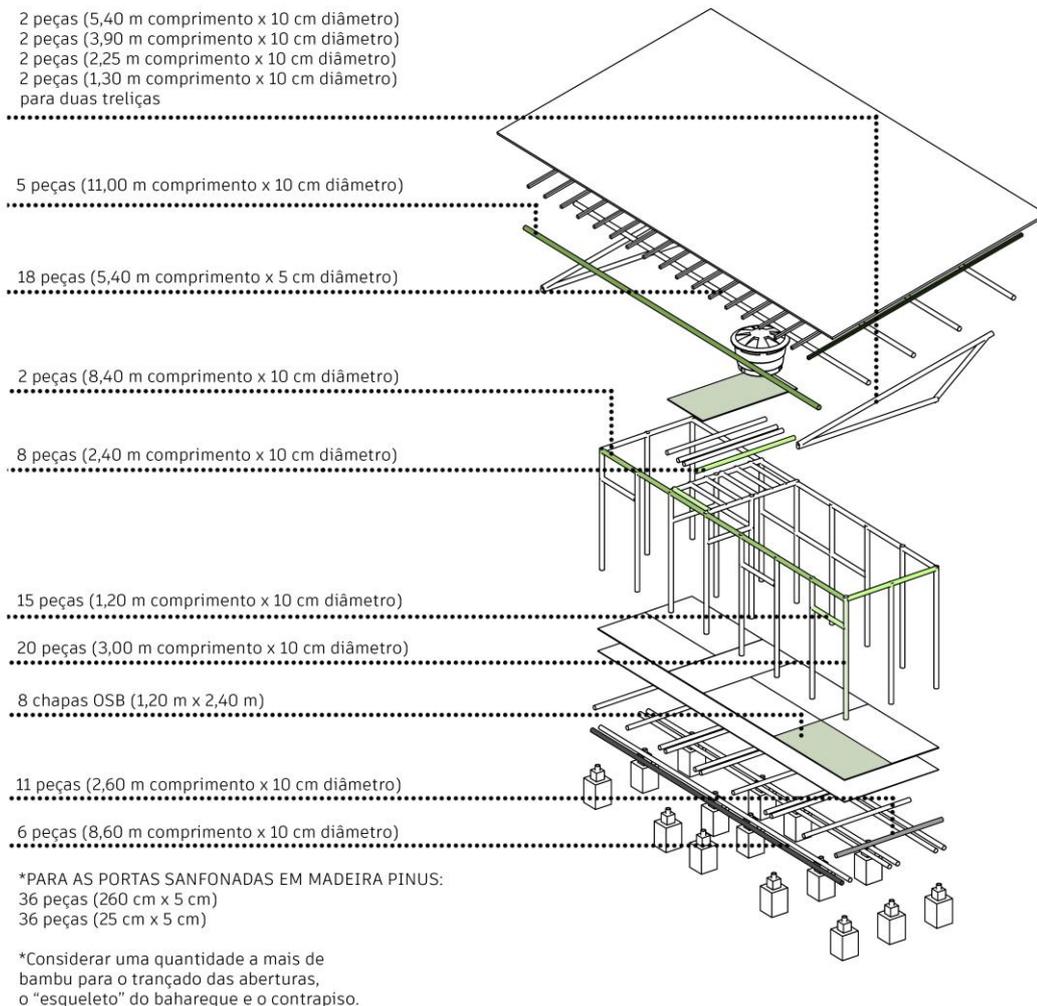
Modulação e contabilização das peças de bambu. Fonte: elaborado pelos autores.
